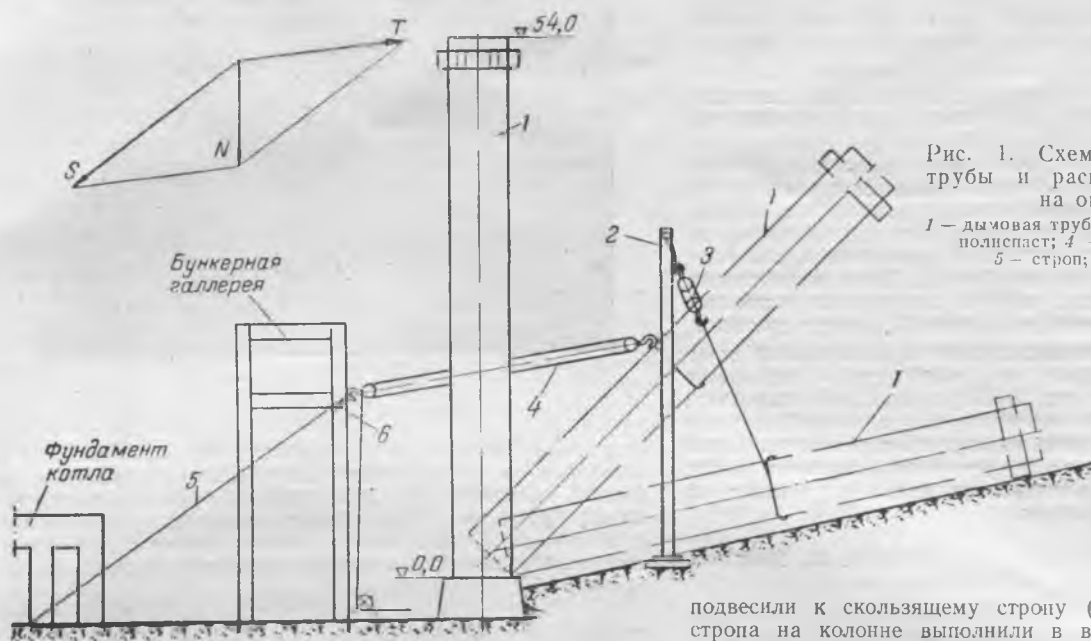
Схема монтажа дымовой трубы и распределение нагрузок на опору строп.
